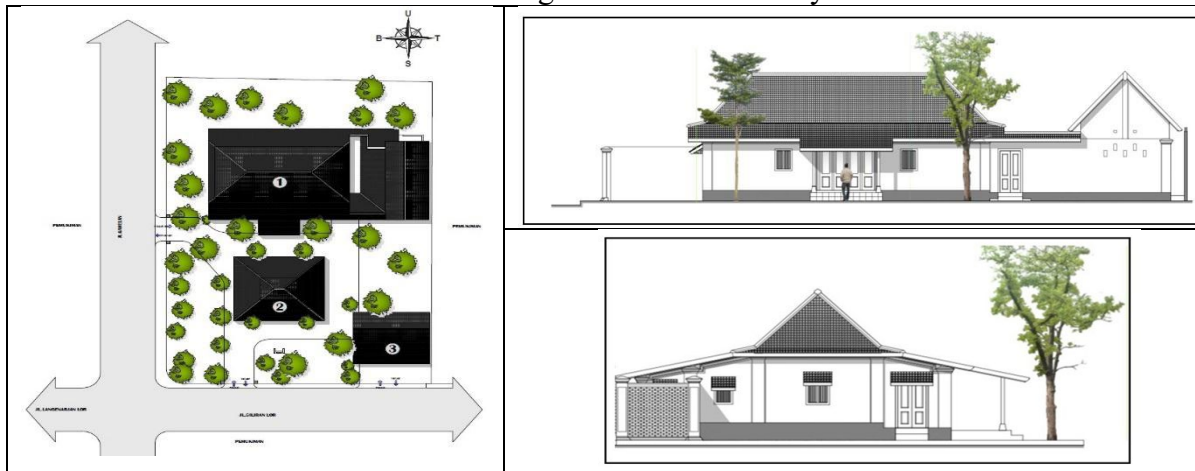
Site dan building existing limasan house ex KRT Kusumo Budhoyo.
